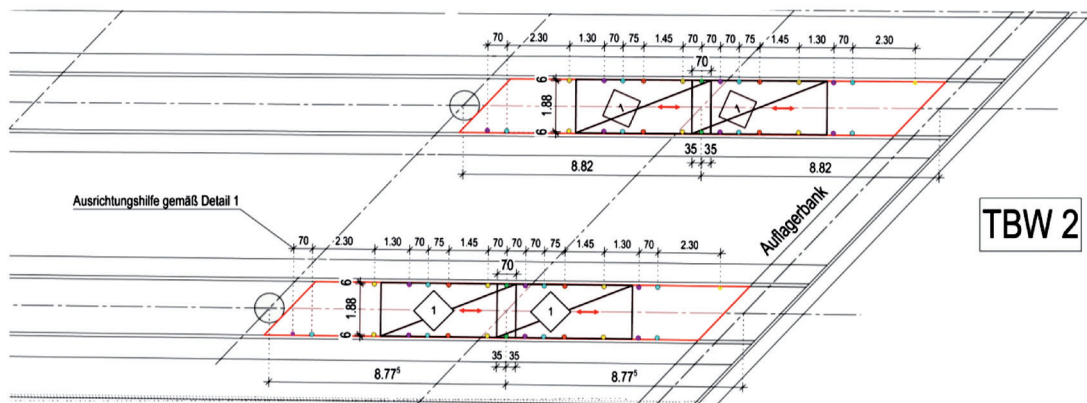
Planauszüge der Ausführungsplanung im Rahmen der Verstärkungsmaßnahme mit Carbonbeton, hier exemplarisch für Teilbauwerk 2; aus [8] Planunterlagen: A. Peter
